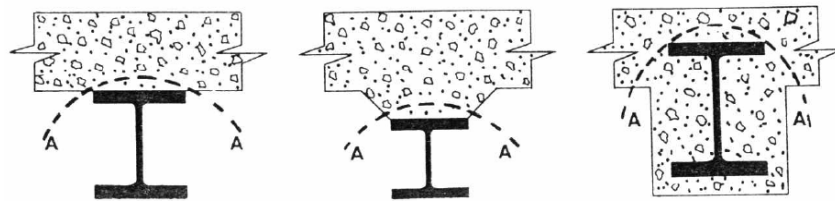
Superfícies de escorregamento em vigas mistas [12]
